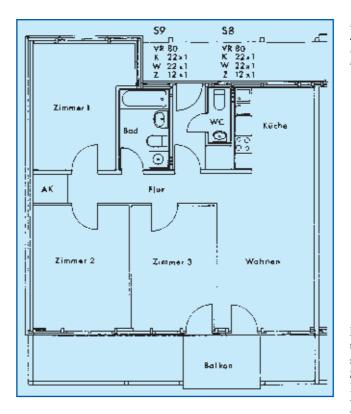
Grundriß der Vierzimmerwohnung in Luckau, mit Bad, WC und Küche
